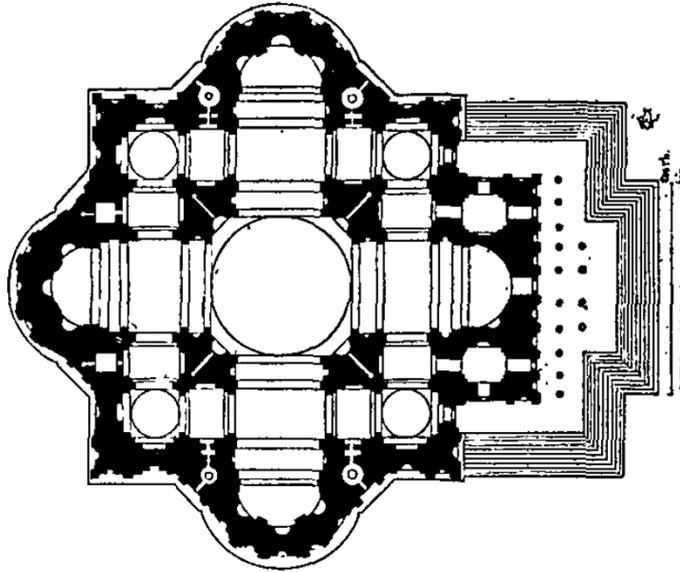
Grundriss des ursprünglichen Petersdoms, Vatikan (Tourist in Rom)
